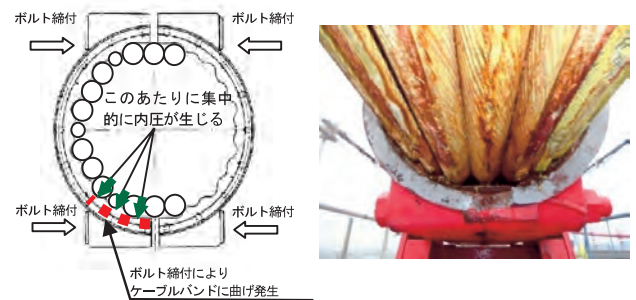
ケーブルバンドの曲げ 写真-25 主ケーブルの滞水跡
